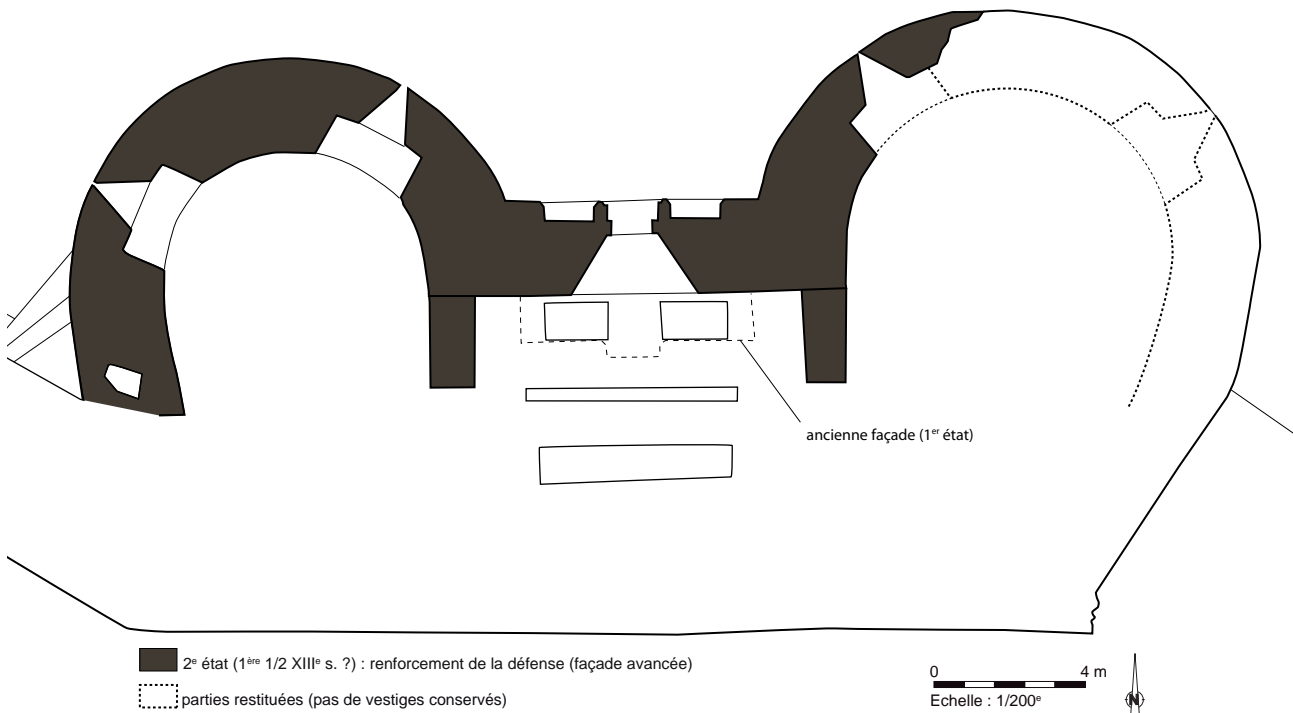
Le plan de l'étage lors de sa construction © E. Cadiou, Inrap
